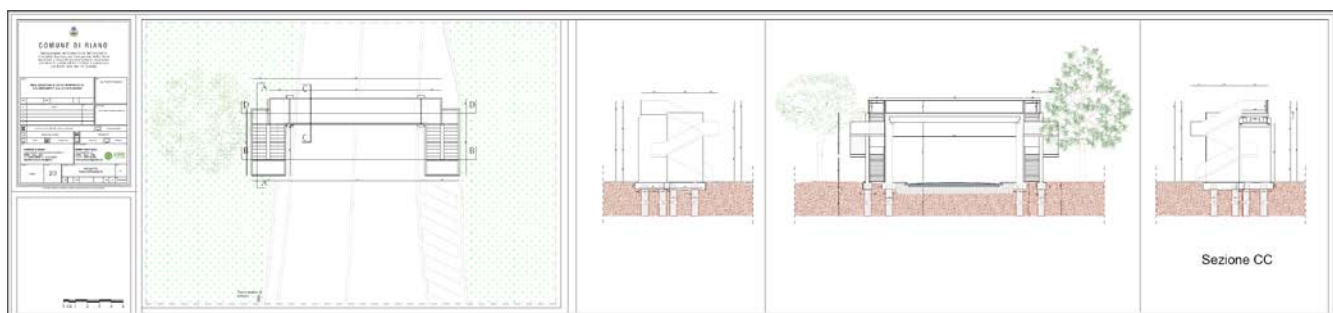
A23: pianta, prospetti e sezioni del sovrappasso.
